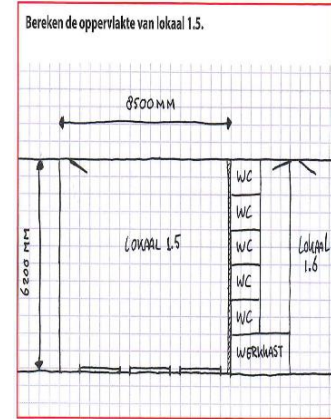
, Handelingsniveau 2: voorstellen – concreet
